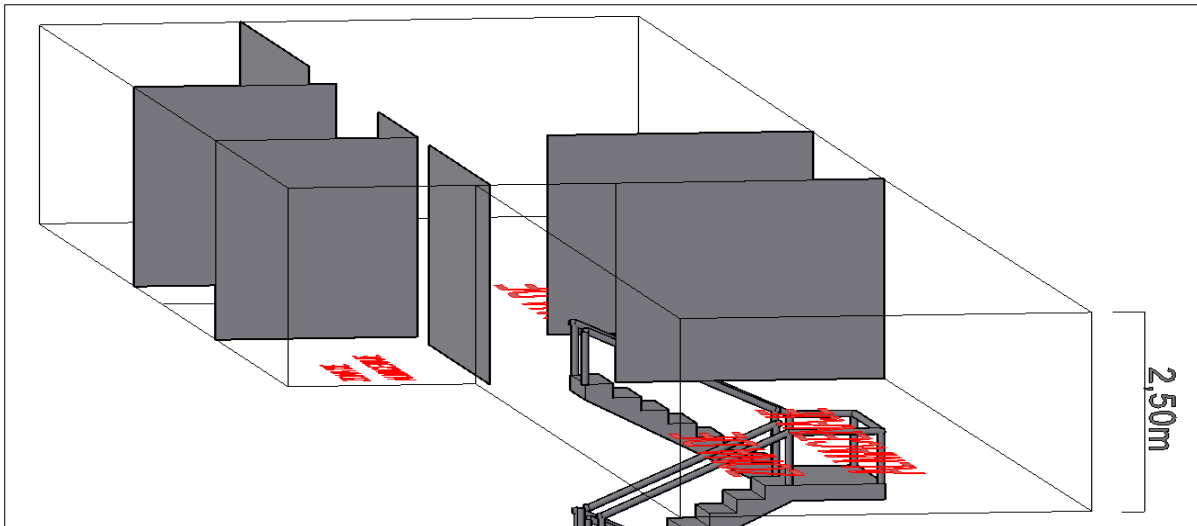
Vista lateral y dimensiones de la tercera planta (plano 2)
